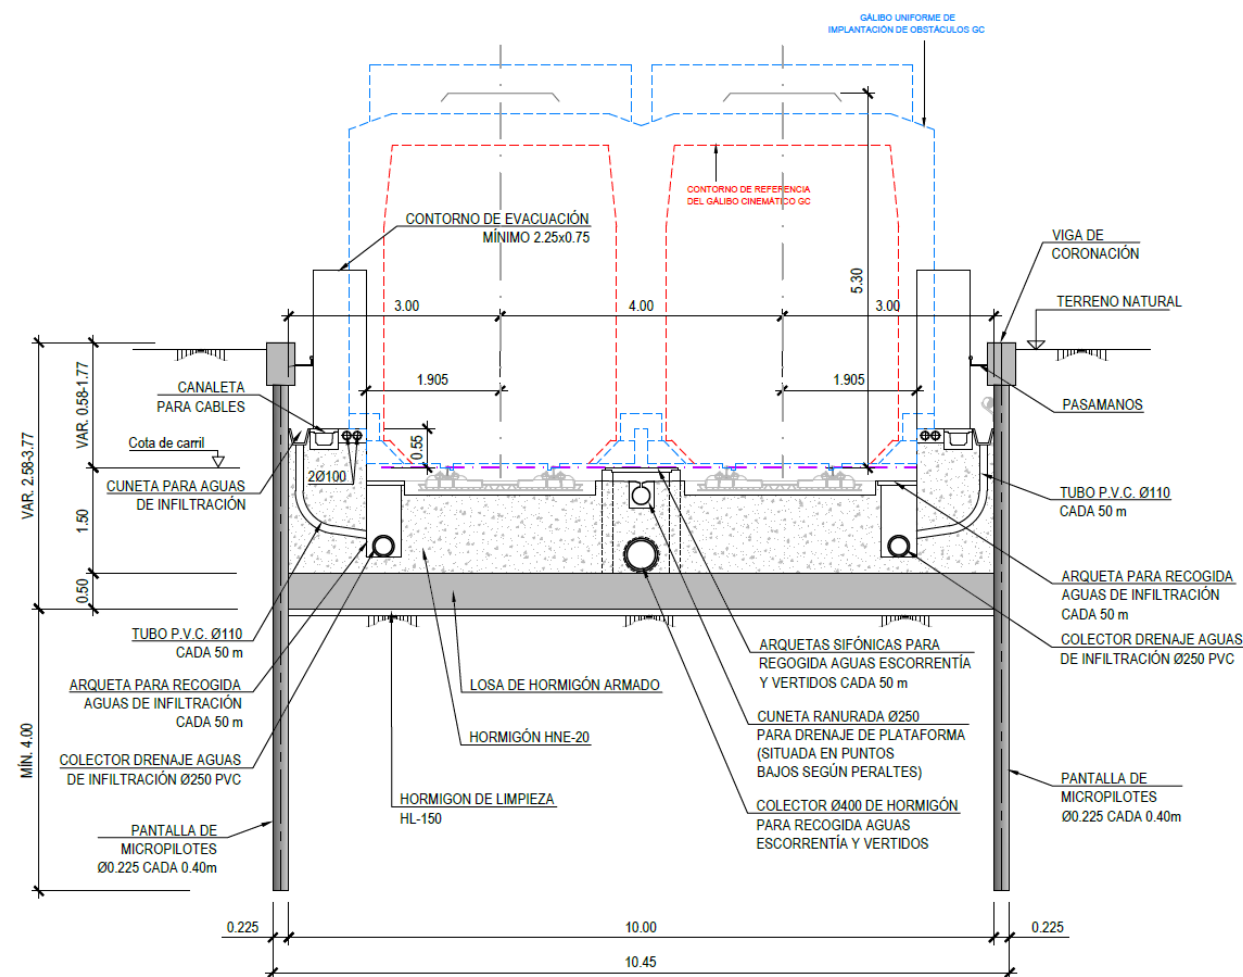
d.- Sección tipo 4 en rampas (ST-MP).
